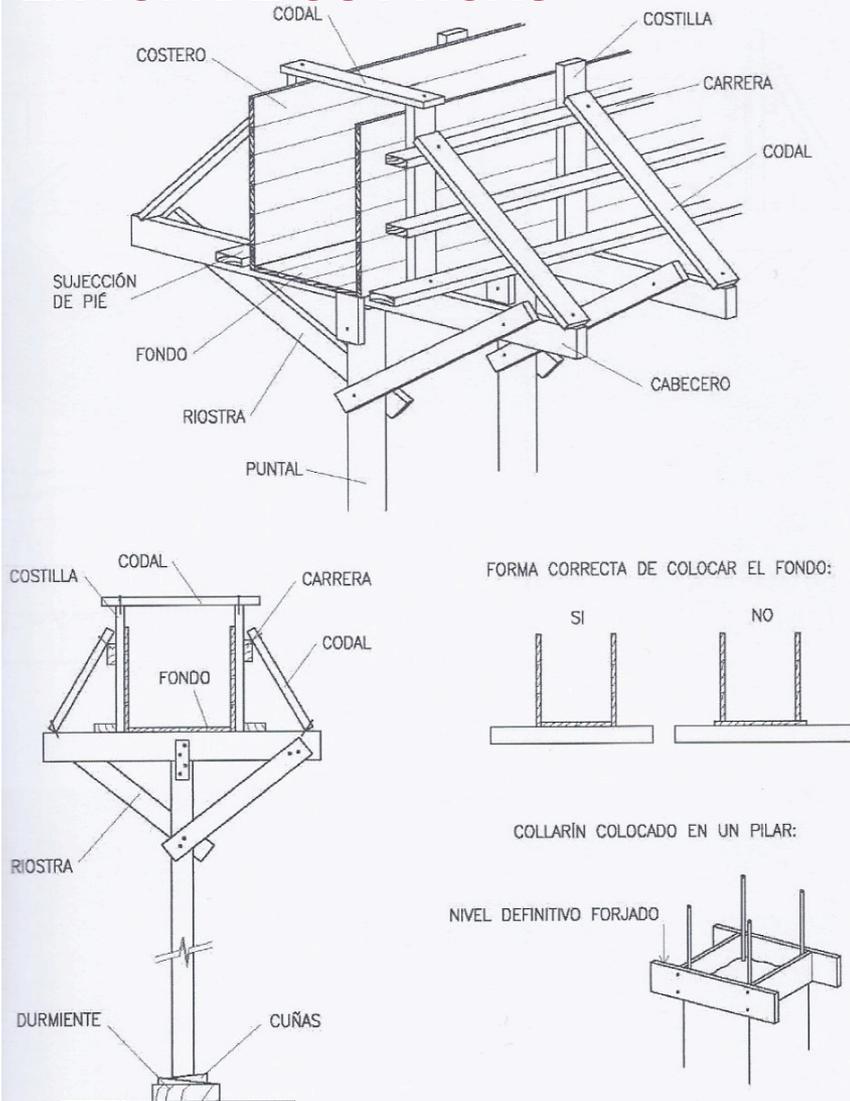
ENCOFRADO DE VIGAS POR EL SISTEMA TRADICIONAL.
